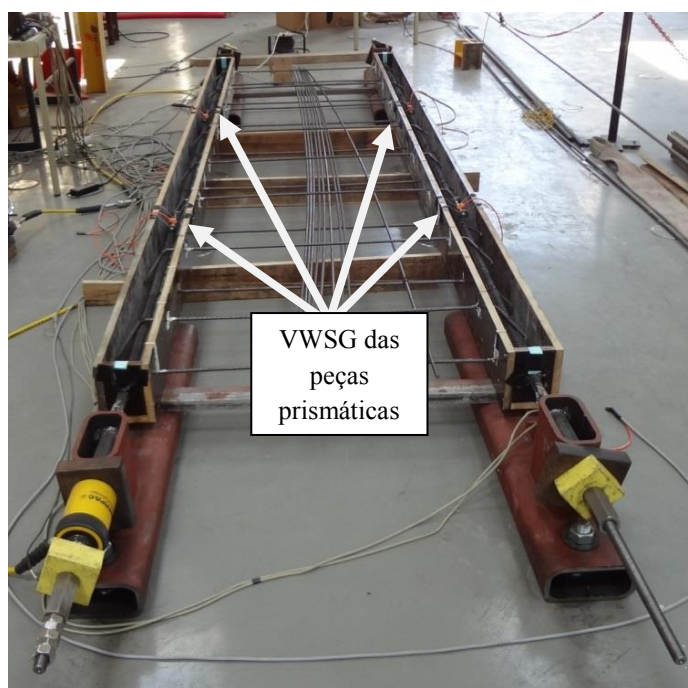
Distribuição dos sensores instalados na 1ª fase de betonagem.
